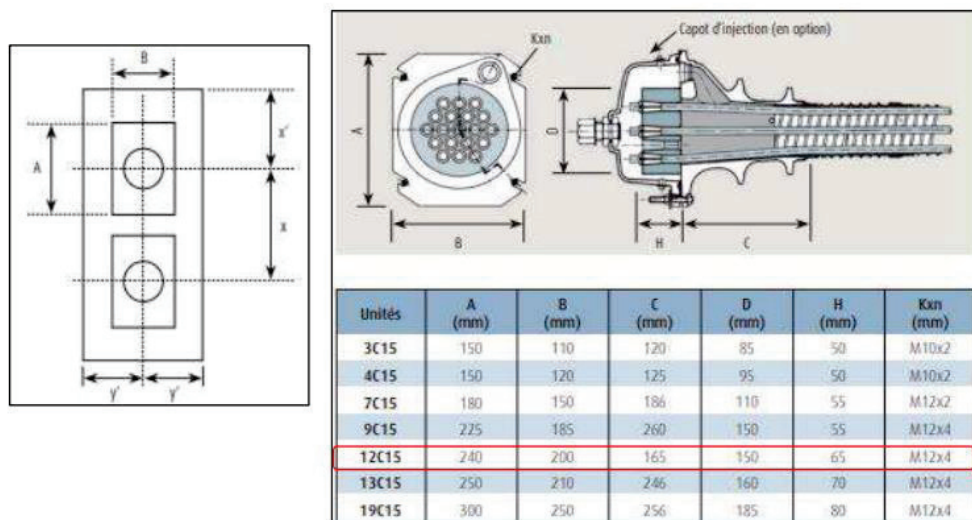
Dimensions et dispositions des plaques d'ancrage.
